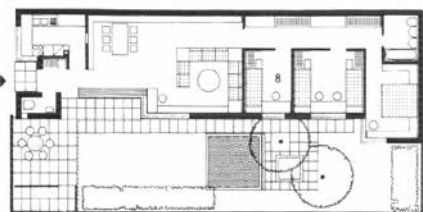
Grundriss Hofhaus, Puchenuau I
